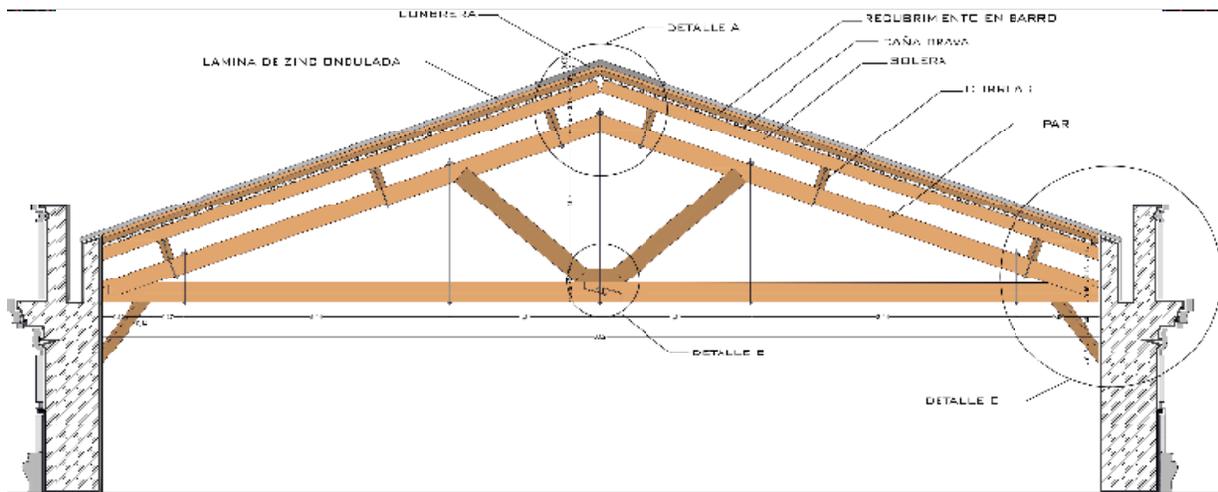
Detalle estructura de cubierta, Estación del ferrocarril Sur.
